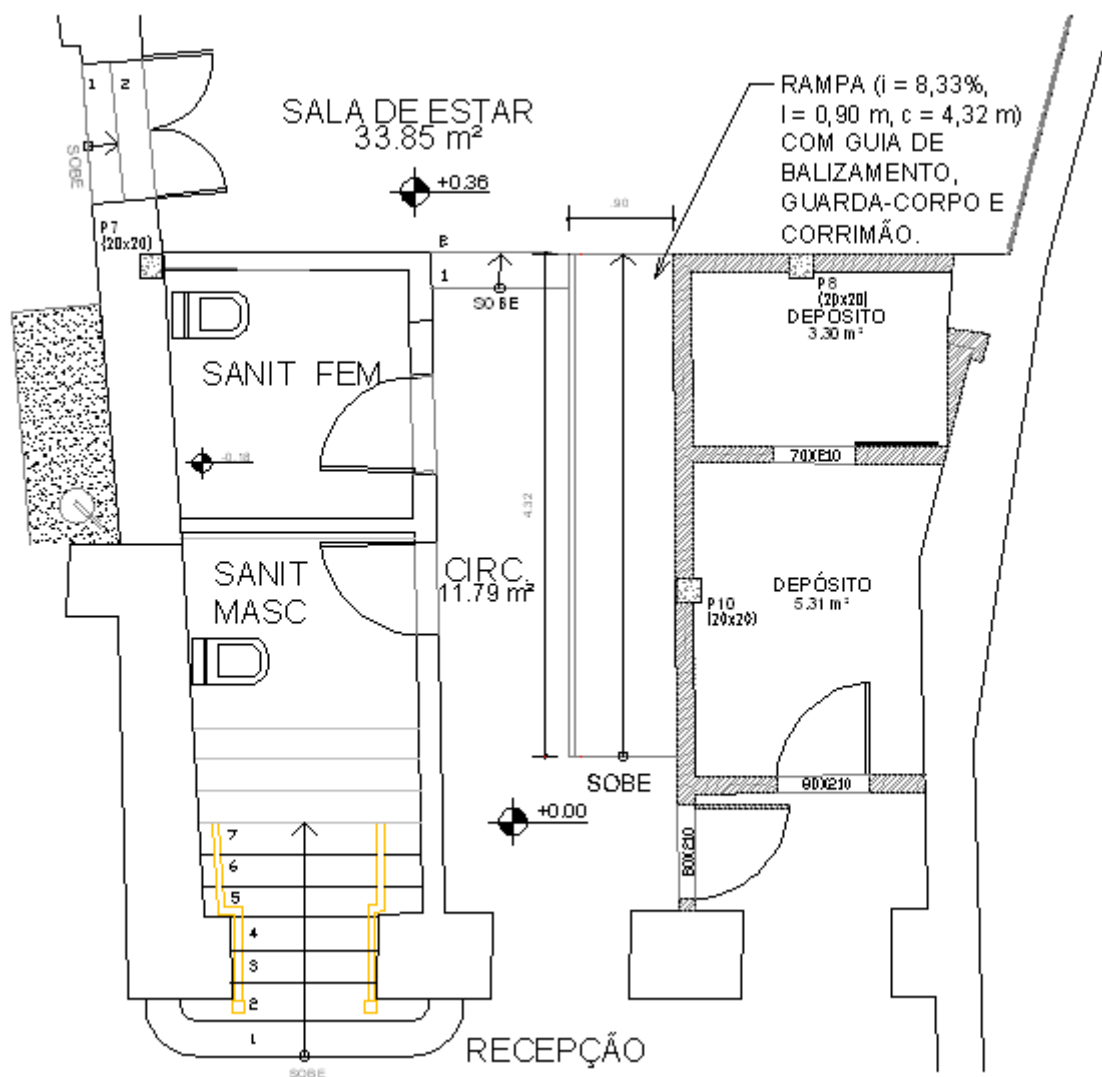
Planta baixa térreo – Hotel Villa Bahia. Rampas de acesso ao bar/restaurante e à recepção.
